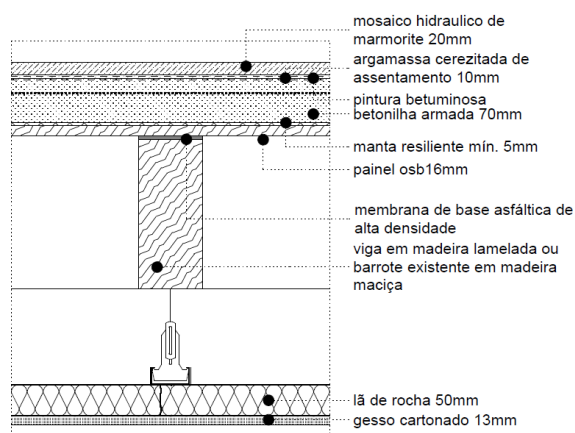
Corte esquemático tipo do pavimento entre fogos nas zonas húmidas.
